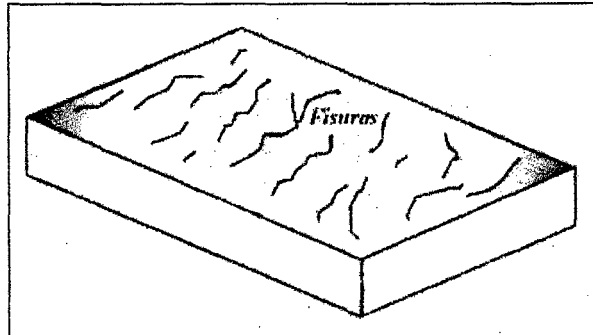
16. Fisuras paralelas en la cara superior de losas debido a la retracción plástica del concreto.
